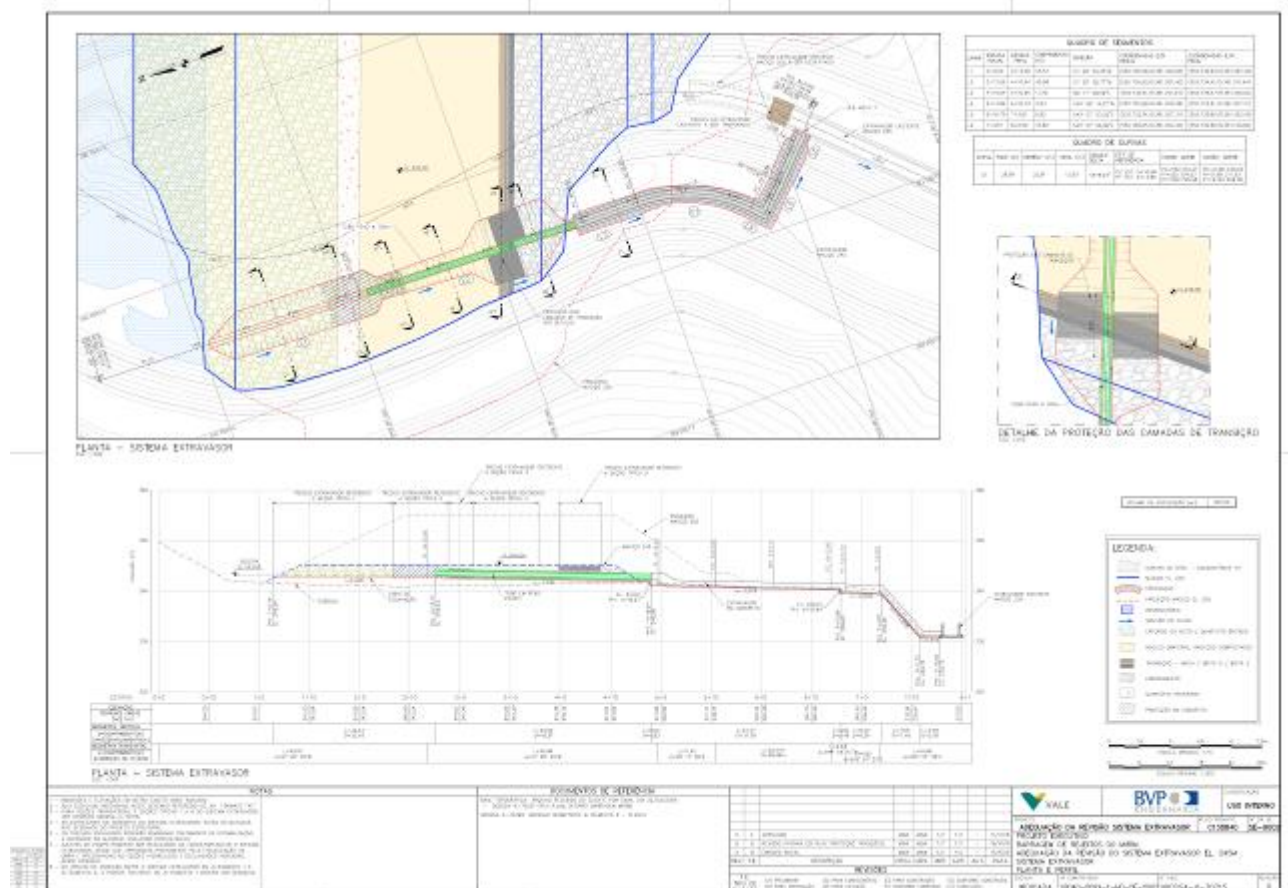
Planta e perfil longitudinal do extravasor da elevação 245,0 m.
